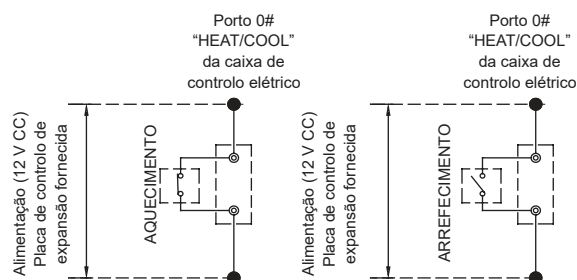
Cablagem do porto eléctrico fraco "HEAT/COOL"
